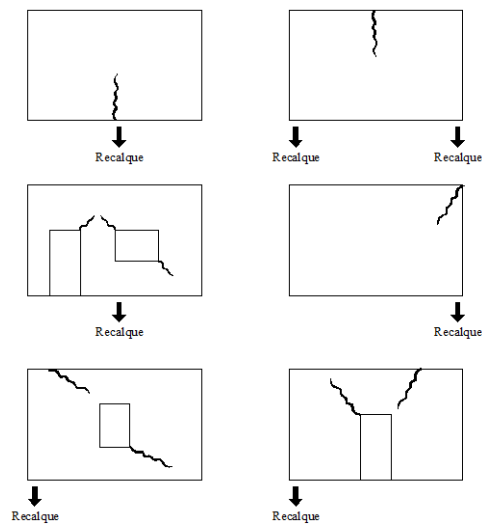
Algumas situações de fissuração em alvenaria devido ao recalque.
